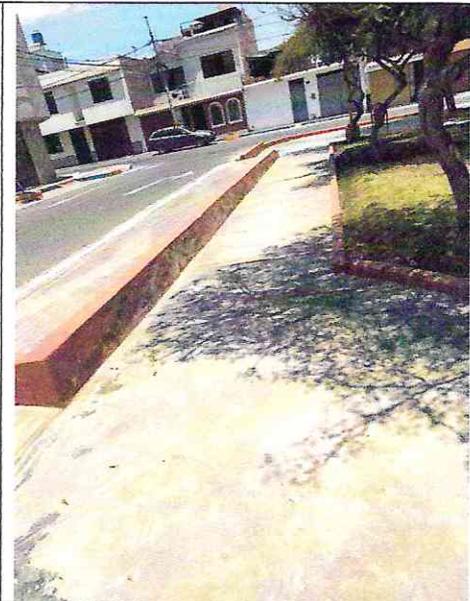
Sardineles de concreto despintados y veredas de concreto con fisuras y desgaste
